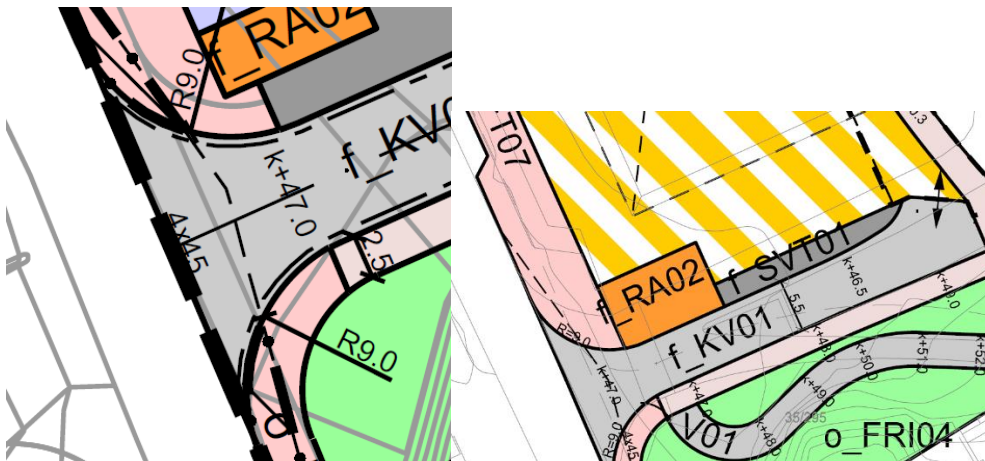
visar gjeldande plan til venstre og nytt felt for energianlegg EA01 til høgre.
